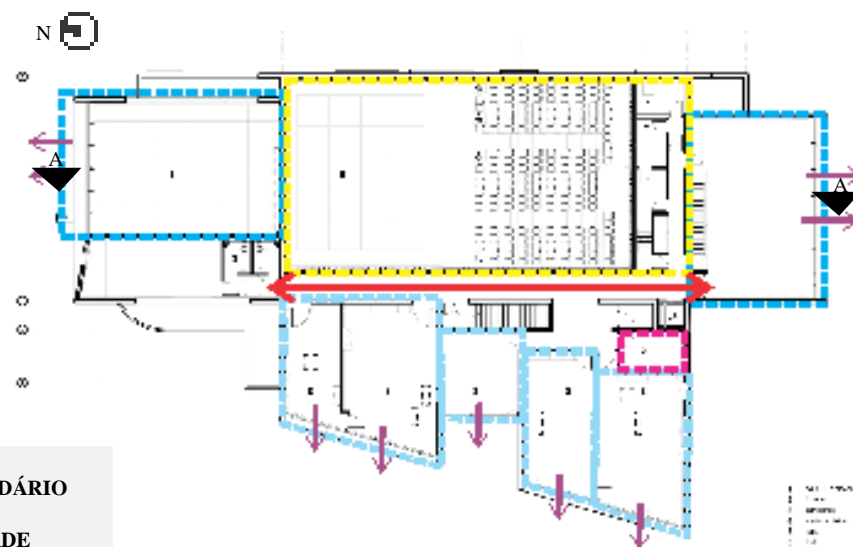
Segundo Pavimento do Centro Cultural De Serdan.
